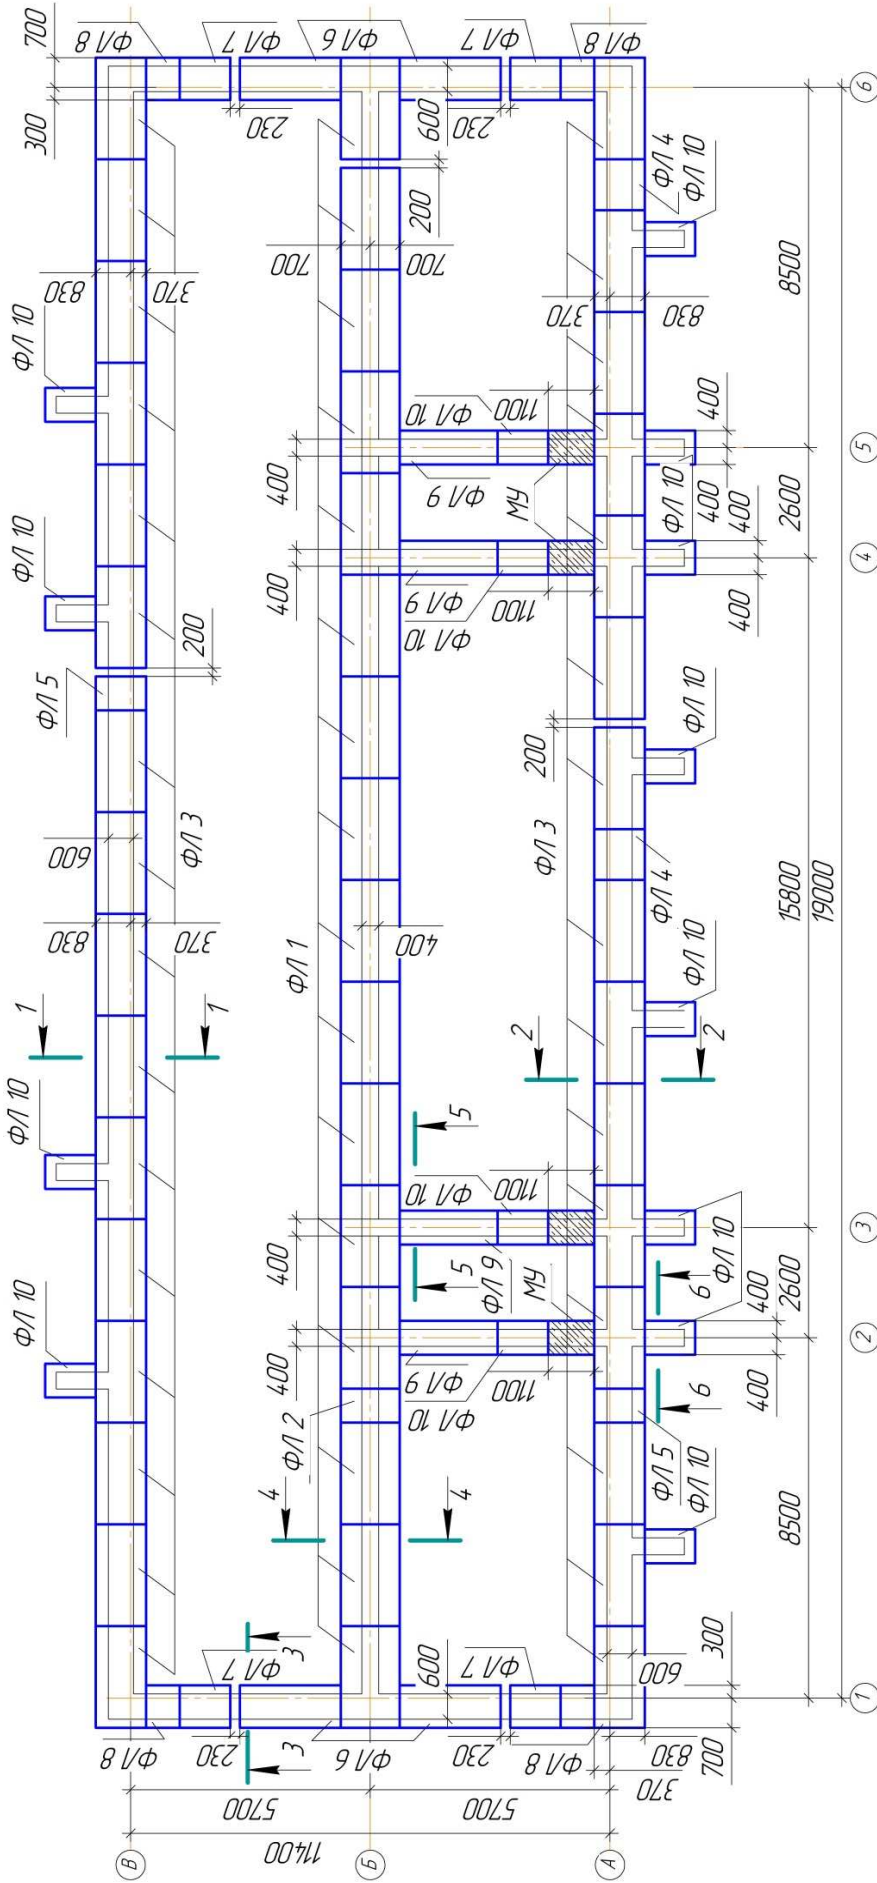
Схема расстановки фундаментных плит ФЛ
